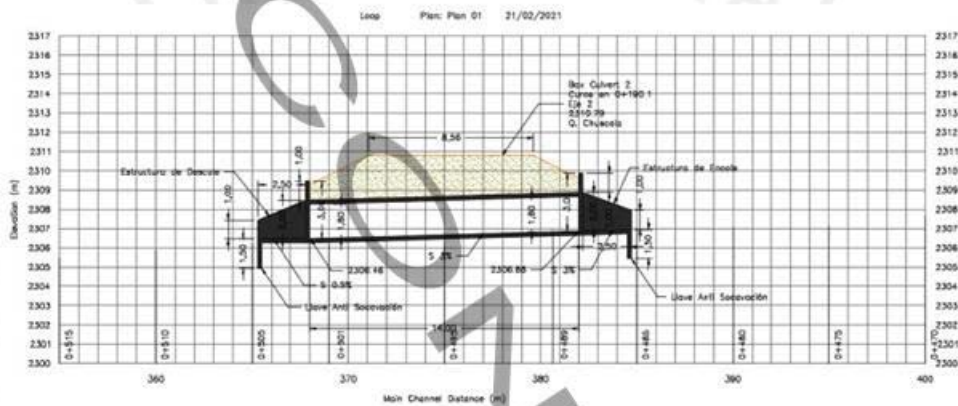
Perfil del Box Culvert (Obra 3) sobre la quebrada Chuscala
